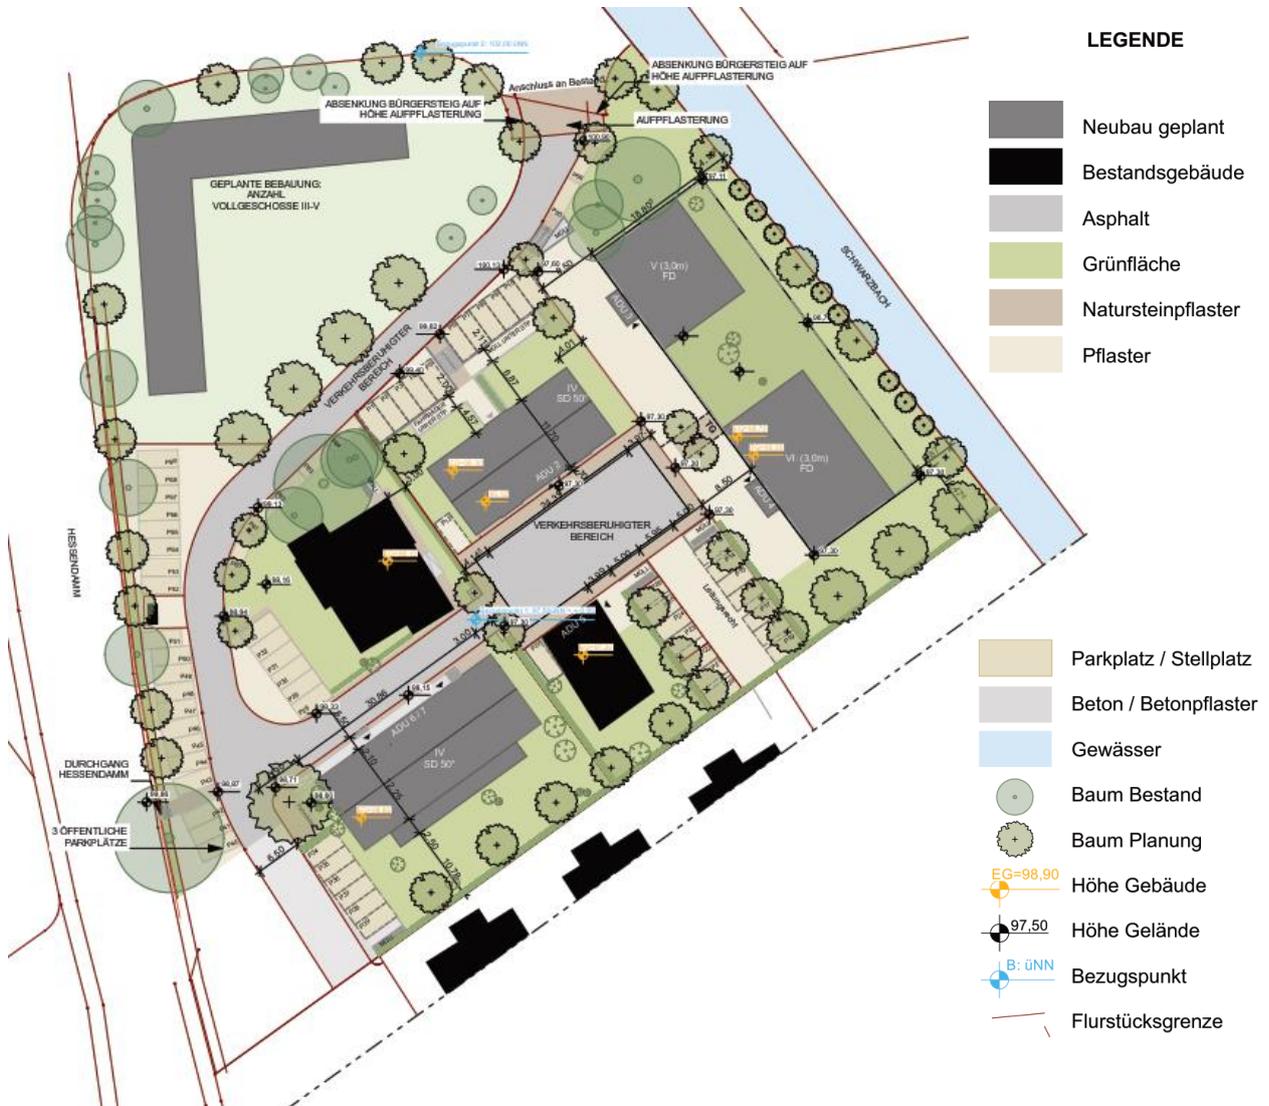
Lageplan städtebauliches Konzept, Stand 08.02.2016
